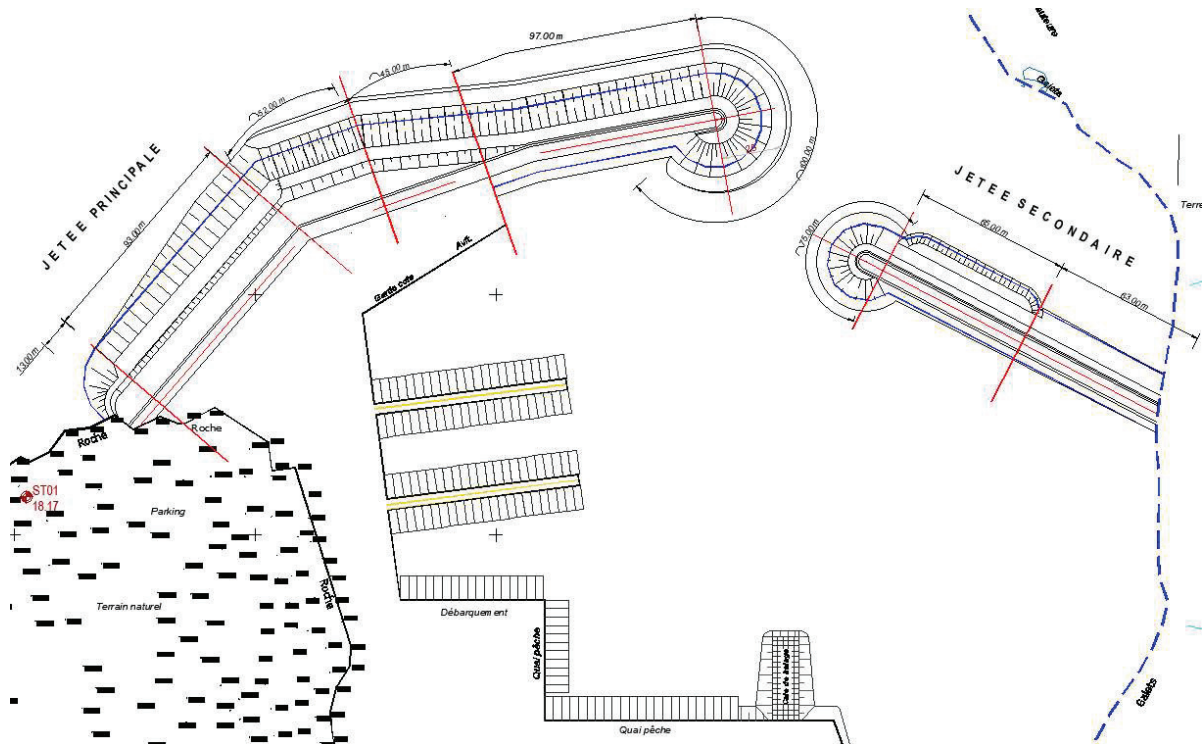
Plan de masse de la variante 2 d'aménagement
